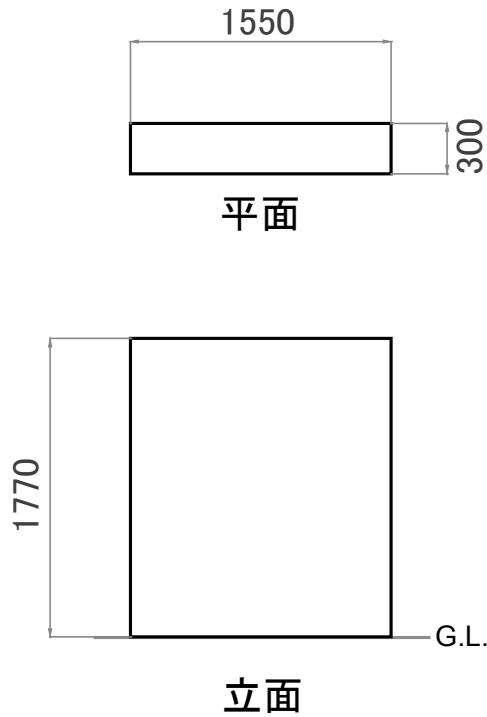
ST 冷蔵前の RC 塀 立面・平面図 (単位 : mm)
